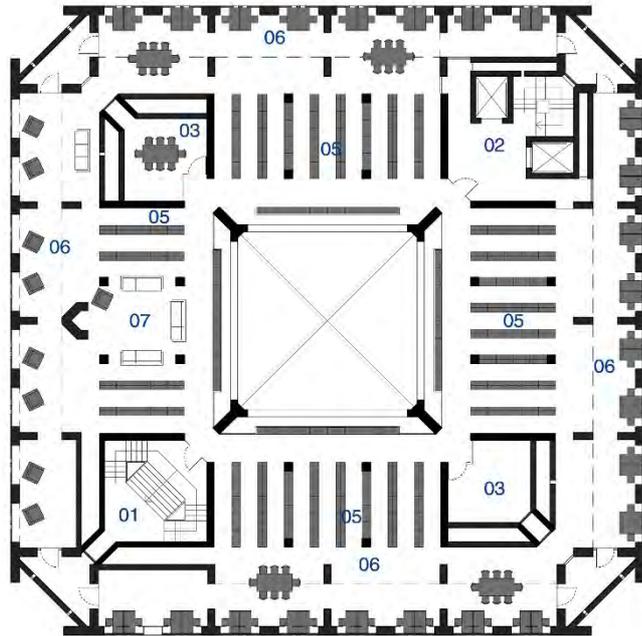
| Planta do sexto pavimento [redesenho do autor]
